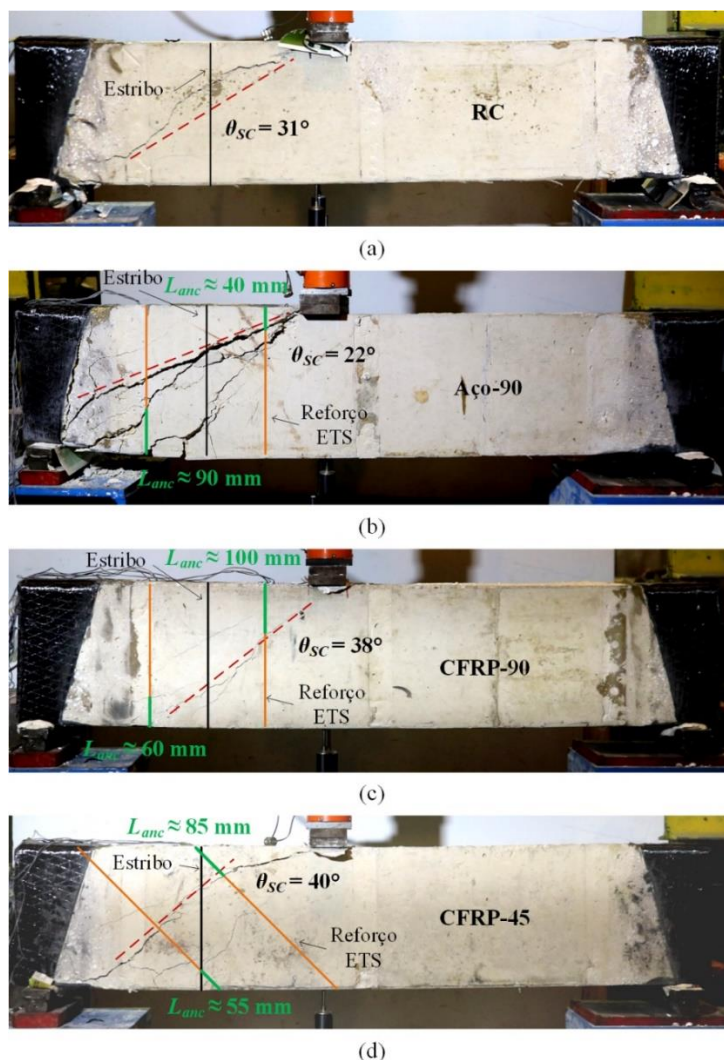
Modos de rotura e inclinações das fendas de corte principais (vermelho, θ_{SC}) em todas as vigas testadas: (a) RC, (b) Aço-90, (c) CFRP-90, e (d) CFRP-45 (reforço ETS a laranja, estribos a preto, e comprimento aderente após fenda, L_{anc} , a verde).
